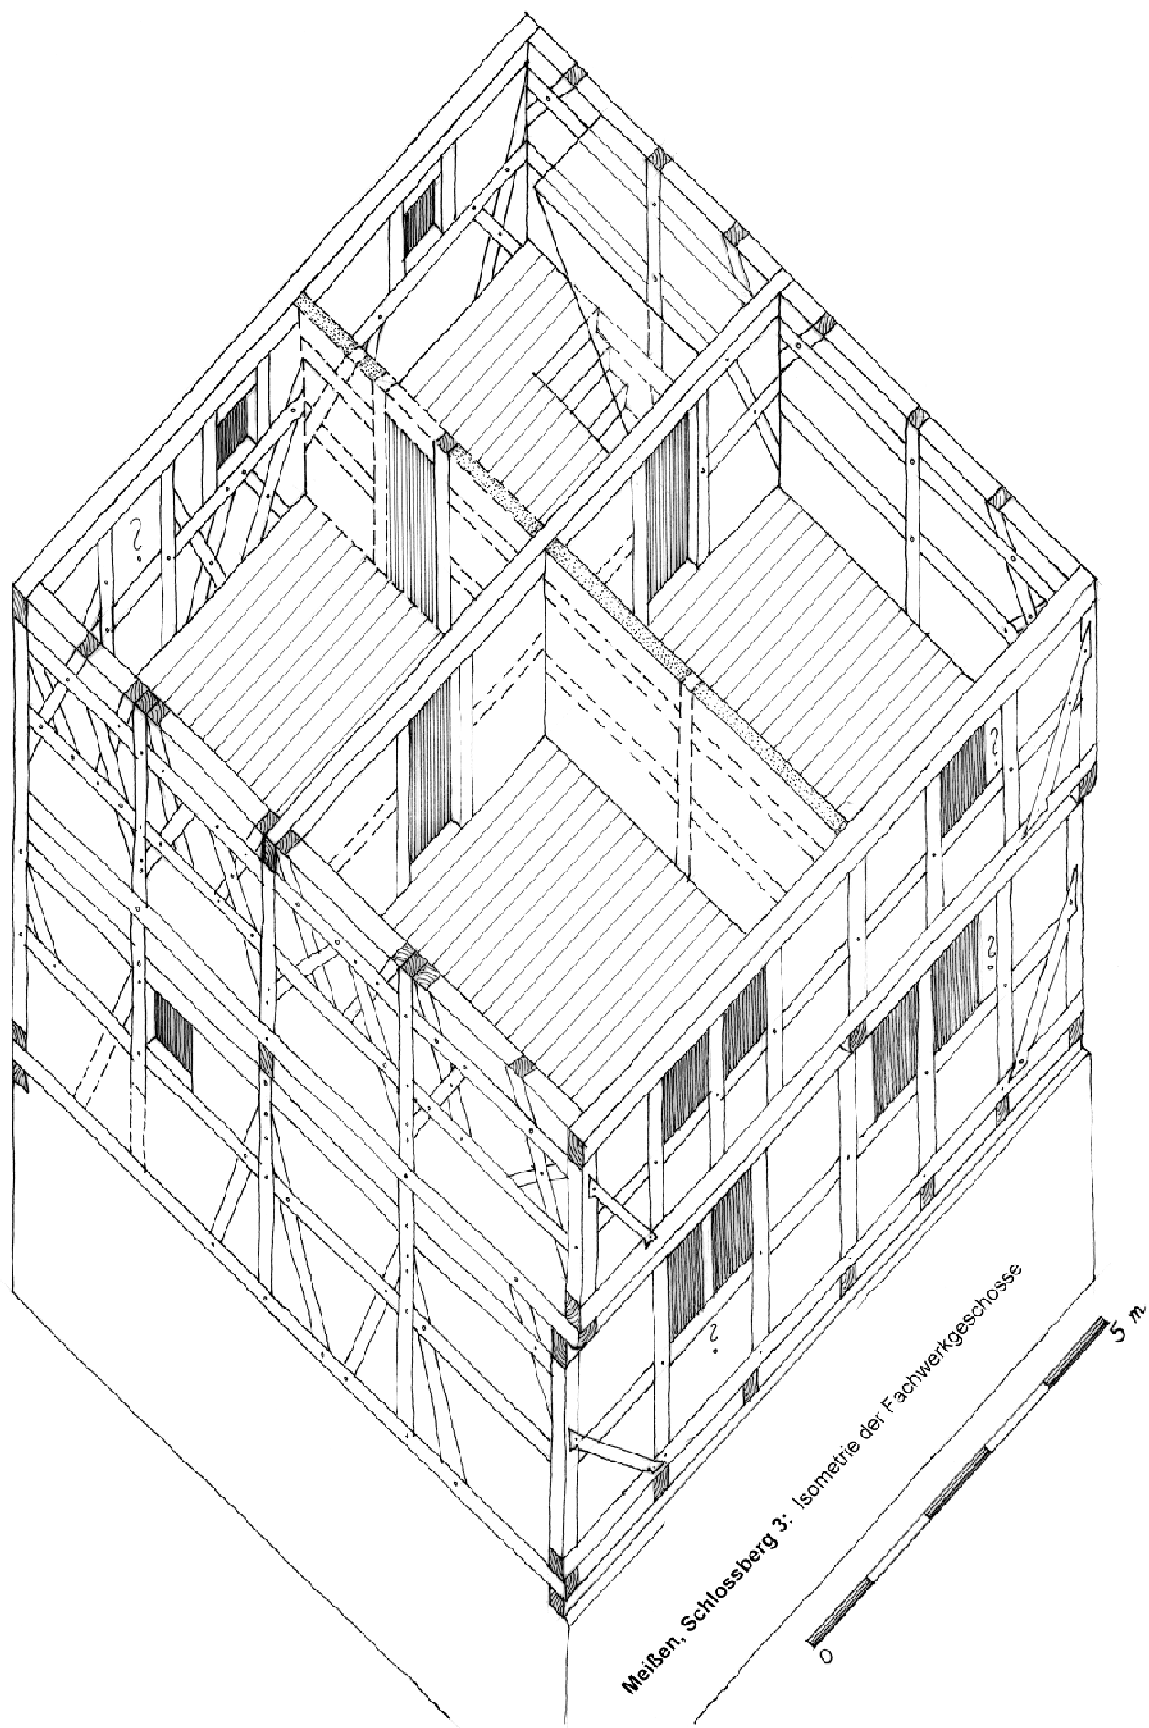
Schloßberg 3, Isometrie der Fachwerkobergeschosse, zeichn. Rekonstruktion
